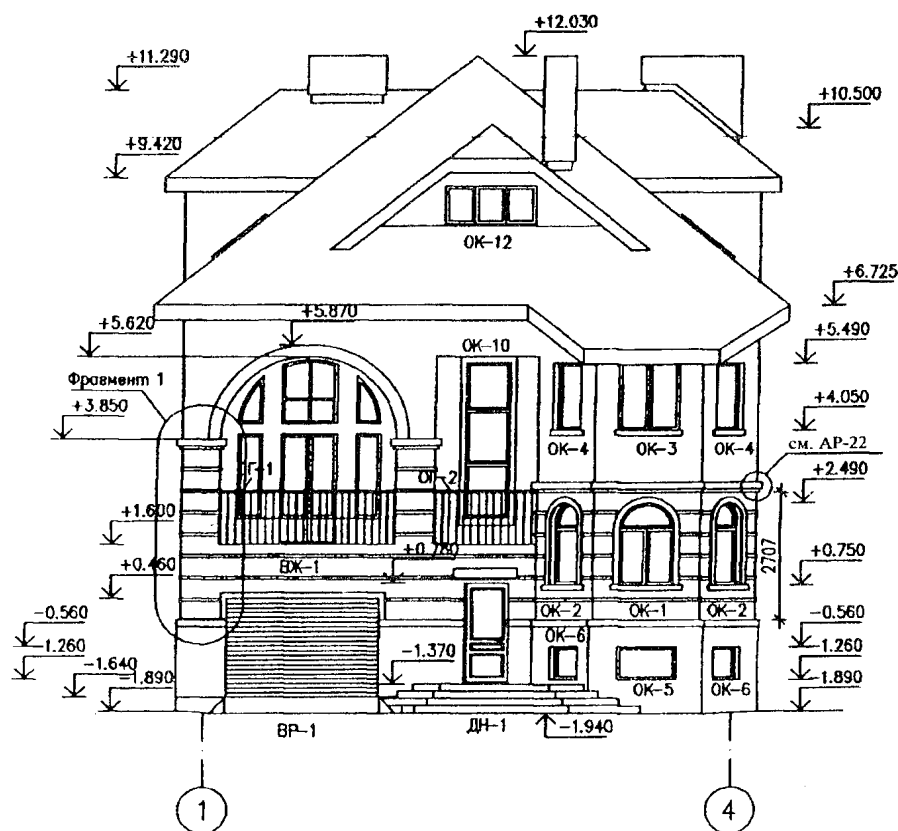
Фасад 1-4 будинку з підвальним поверхом
